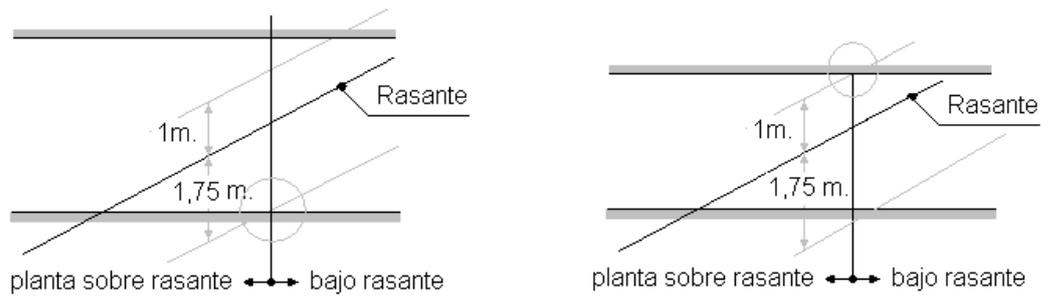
Determinación de planta sobre y bajo rasante
